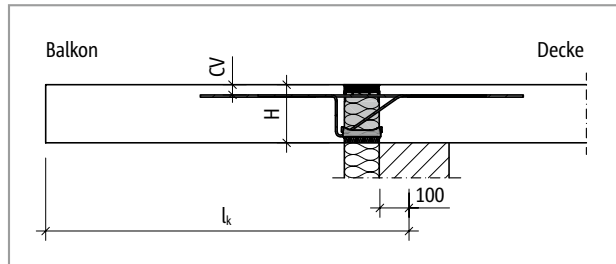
Schöck Isokorb® XT Typ K-M1 bis M10: Statisches System
